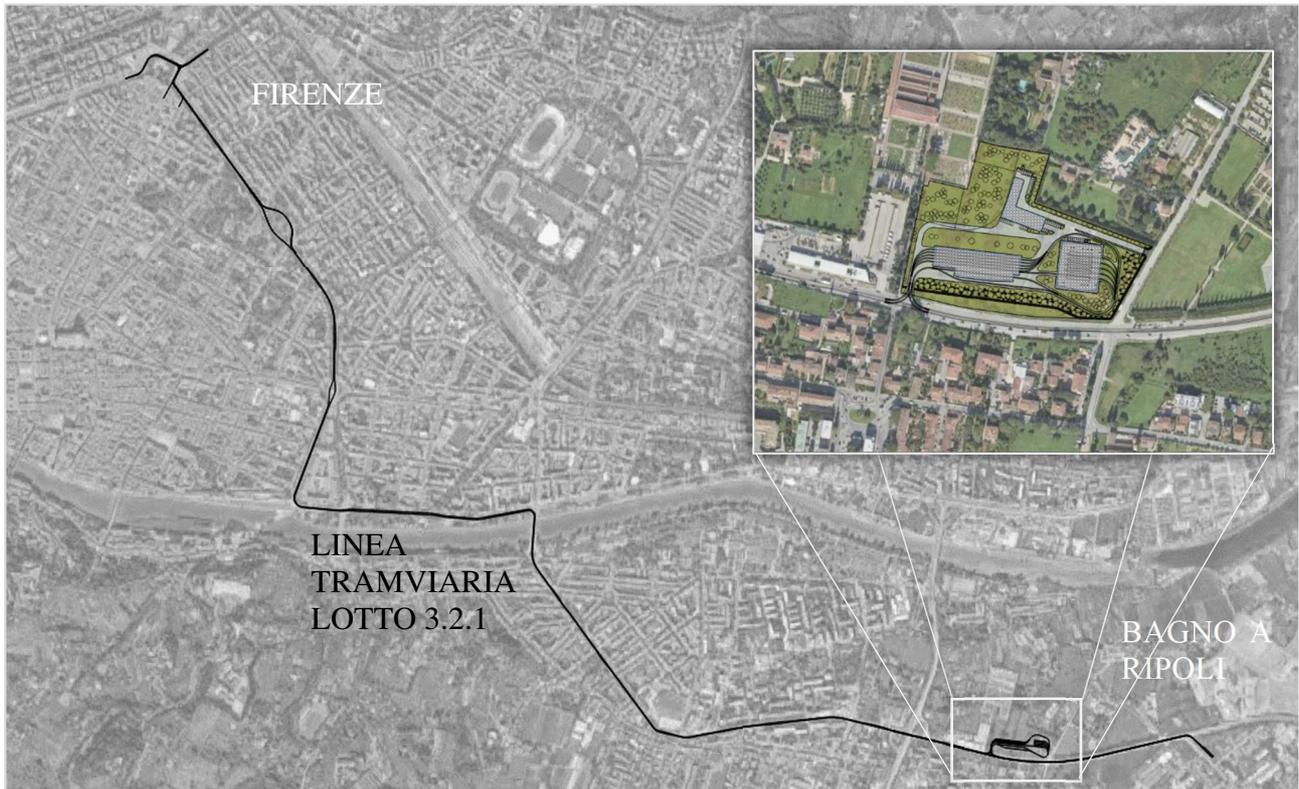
Planimetria di progetto della linea 3.2.1 Libertà – Bagno a Ripoli
